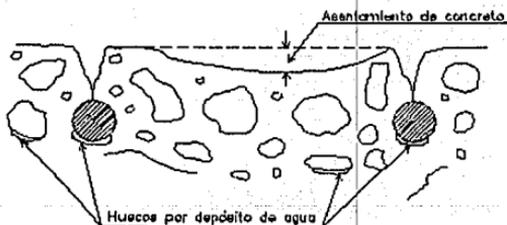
Cuarteaduras sobre las barras por secado prematuro del concreto.
